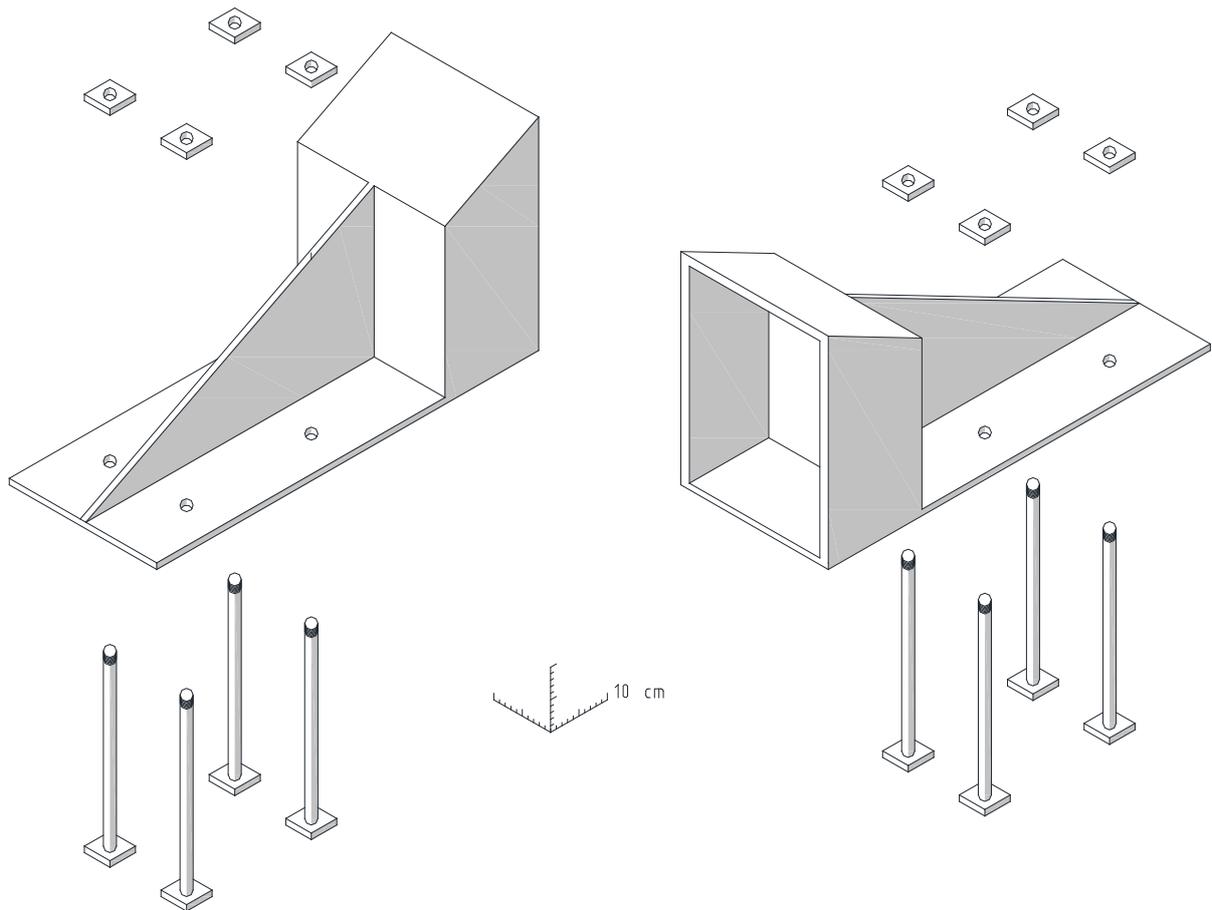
Einsteighalle in Hof, Eisenschuh als Verbindungsdetail von Strebe und Zerrbalken
